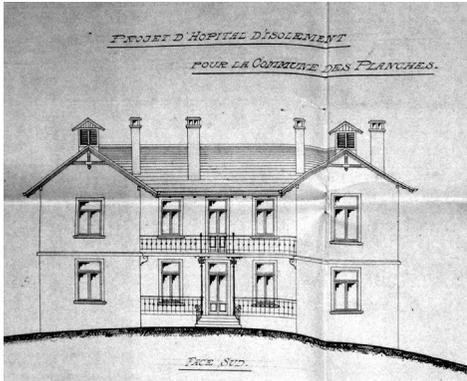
Montreux, lazaret des Planches, élévation de la façade sud, Henri Lavanchy architecte, 1896 (AM).
